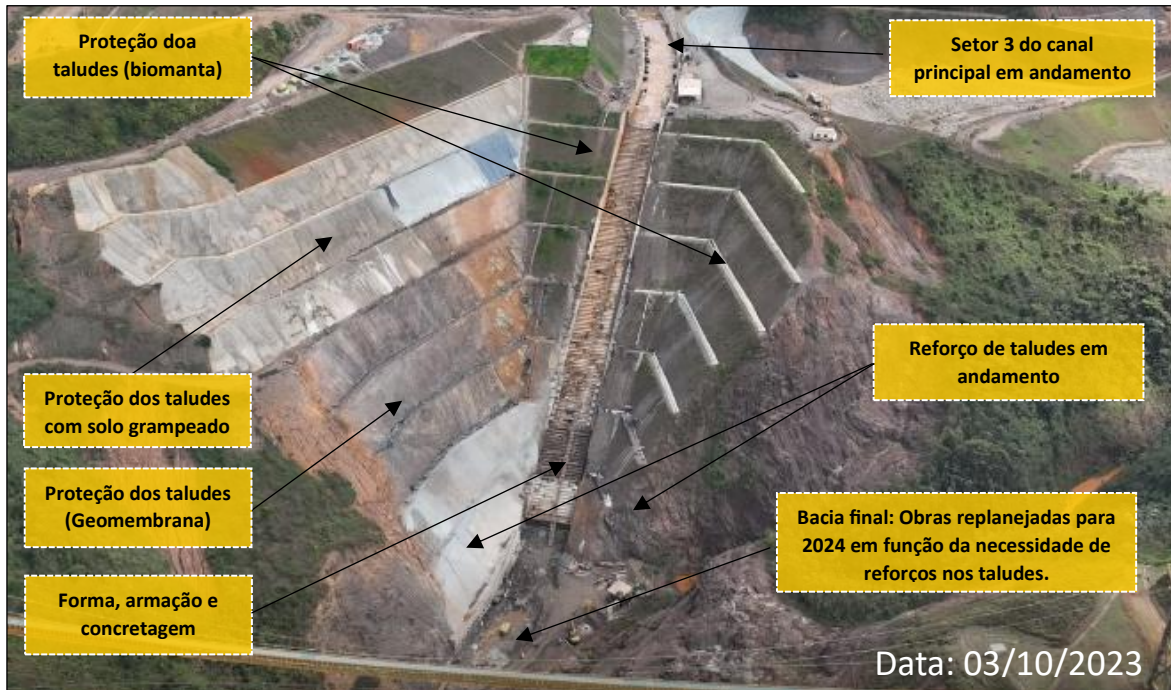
Vista do Setor 4 do Canal Principal e Bacia Final – Estrutura do Canal e Proteções de Taludes Em Andamento
